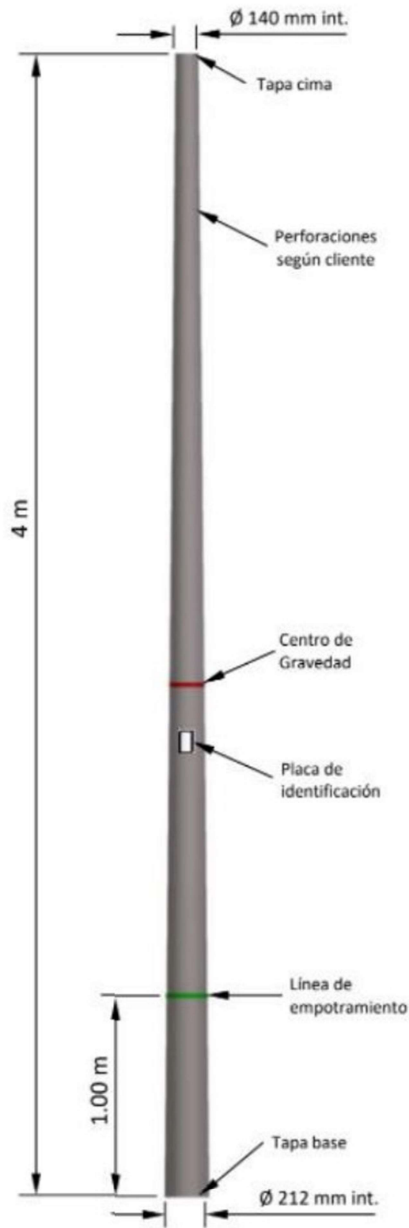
Esquema instalación poste fibra de vidrio según fabricante
